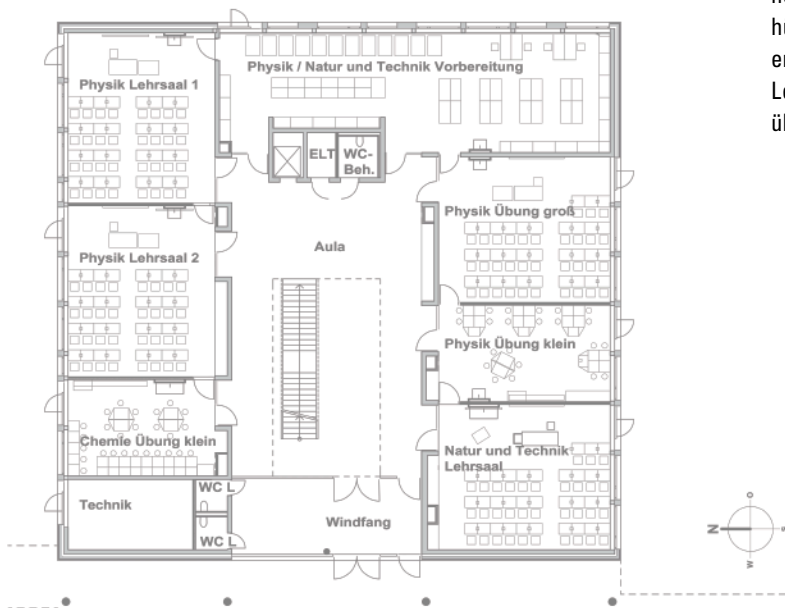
Erdgeschoss-Grundriss des Neubaus, Bauteil B
